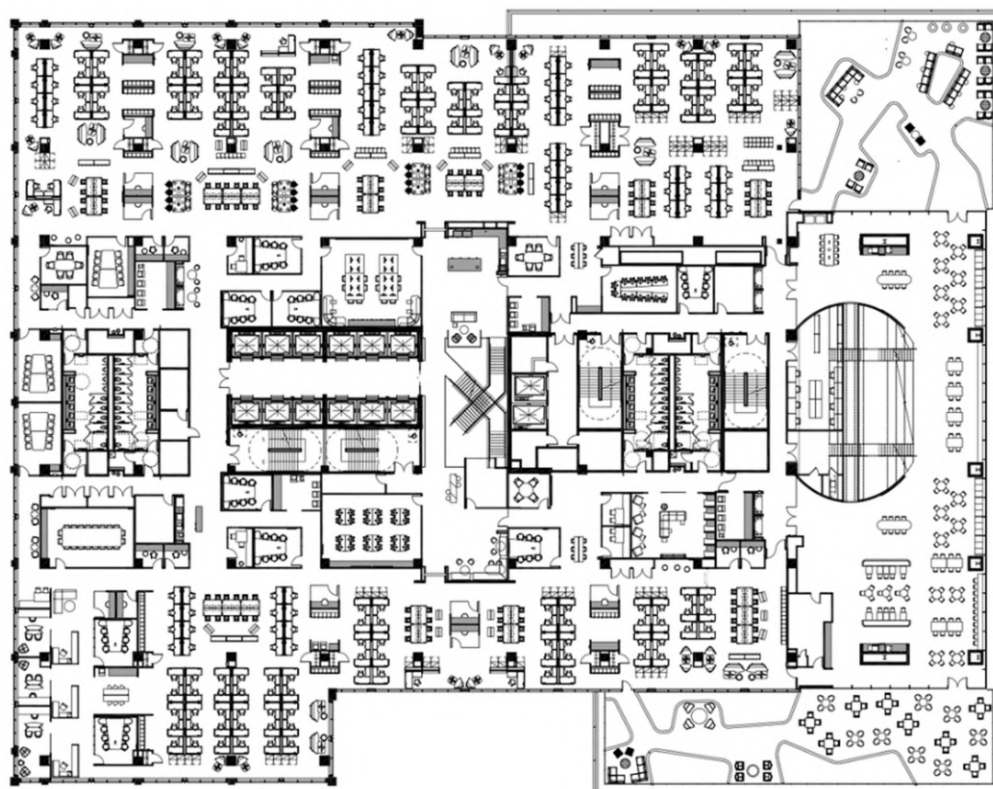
План першого поверху, США, арх. IA Interior Architects, Studio O+A, 2018 [10]
